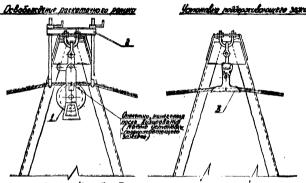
Узел Б. Перекладка ерозозацитного троса
